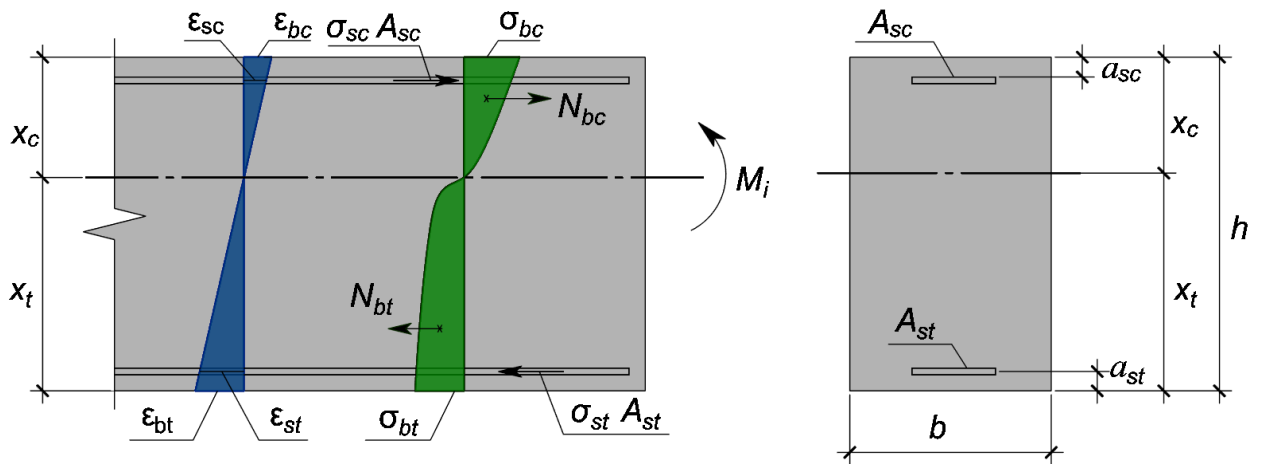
Схема распределения относительных деформаций, напряжений и усилий в сечении изгибаемого железобетонного элемента прямоугольной формы на этапе его работы без трещин
